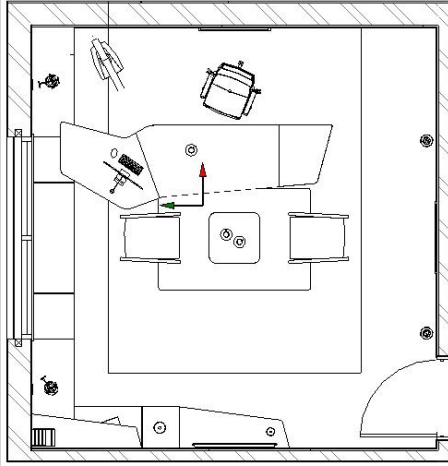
كروكي للمسقط الأفقي للتصميم
